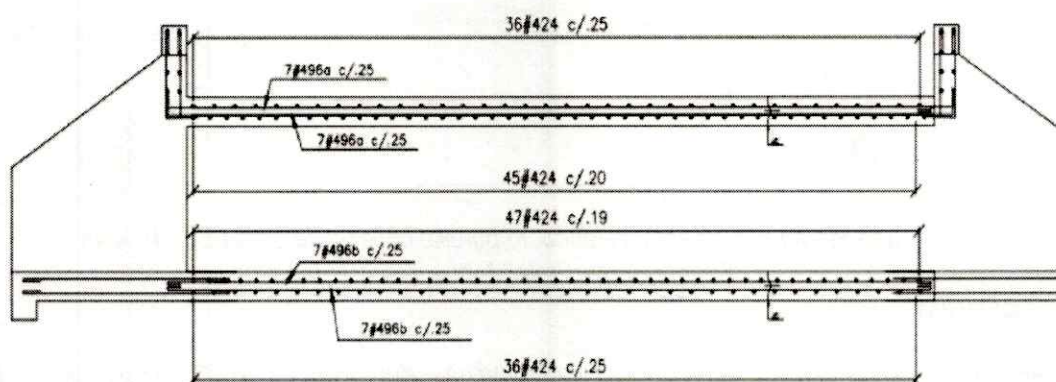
Corte sección transversal geometría y refuerzo Box Culvert 1.5m X 1.5m
